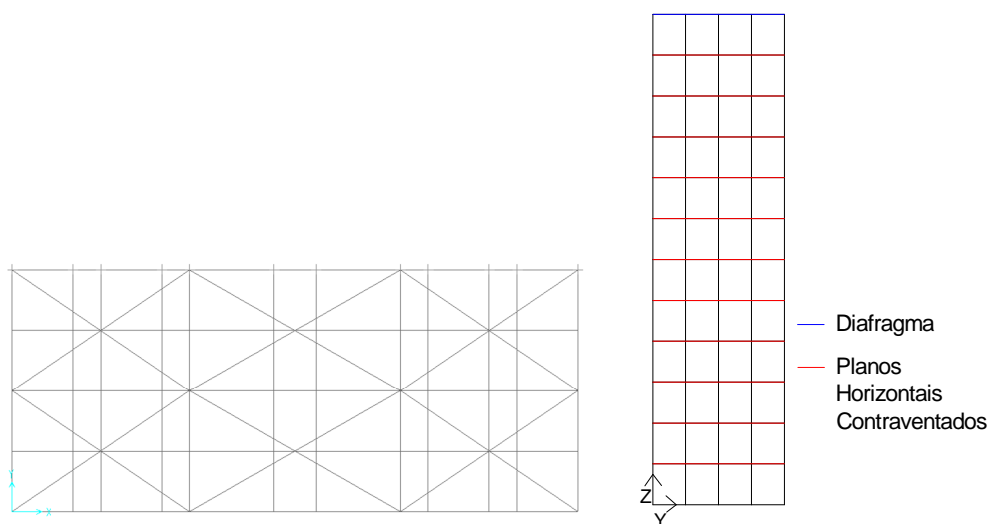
Configuração dos Planos de Contraventamento Horizontal Com Elementos de Contraventamento Grandes
